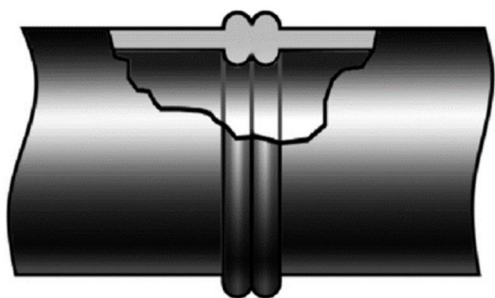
Стыковое сварное соединение труб из ПЭ систем газоснабжения
